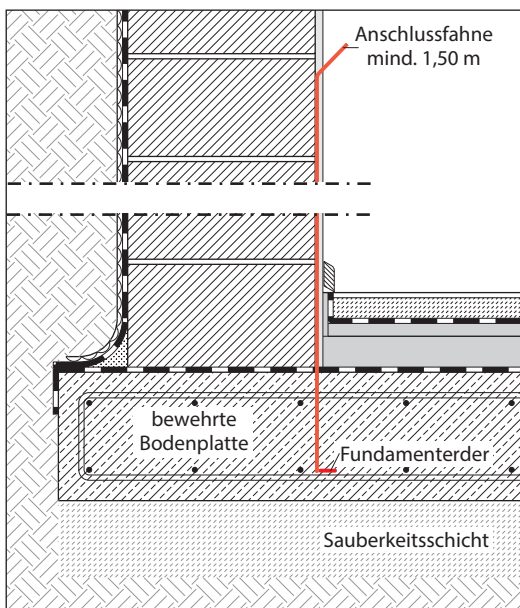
Ausführung des Fundamenterders im bewehrten Fundament
